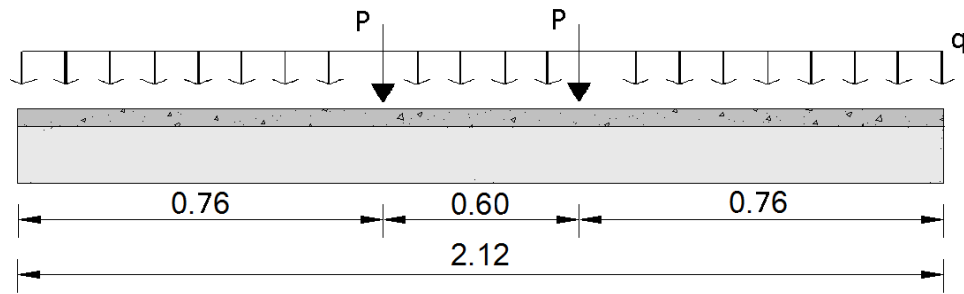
Detalhe da vista lateral da viga e de seu carregamento
